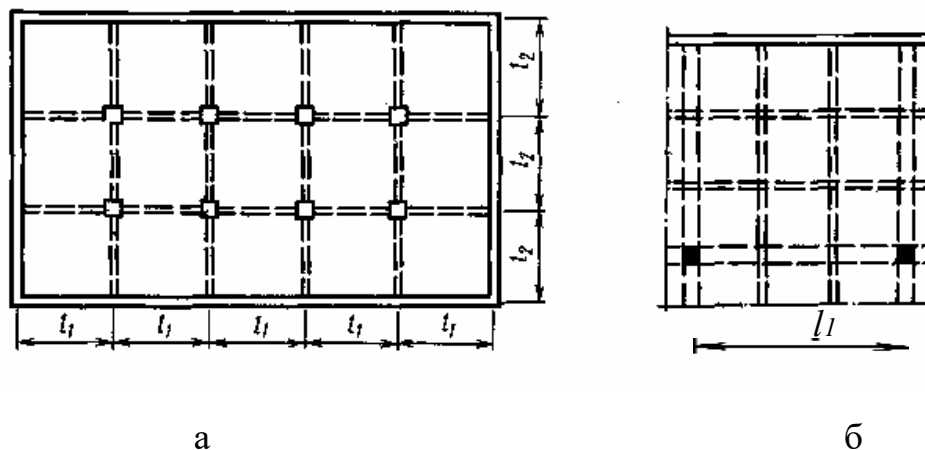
Конструктивні схеми монолітних ребристих перекриттів з плитами, опертими по контуру:
